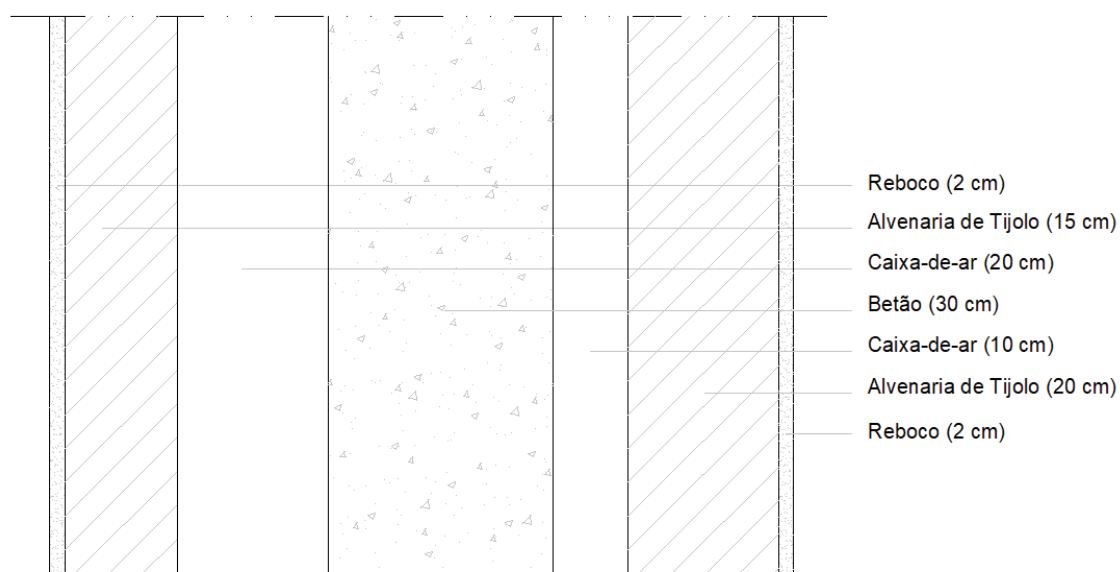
Pormenor construtivo da parede interior tipo IV (estacionamento cota 4.1)
